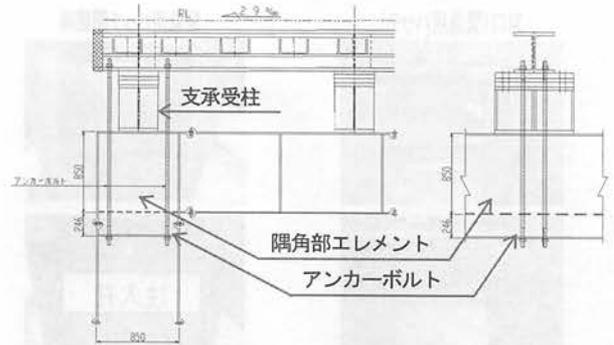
工事桁浮き上がり2次対策アンカーボルト断面図
